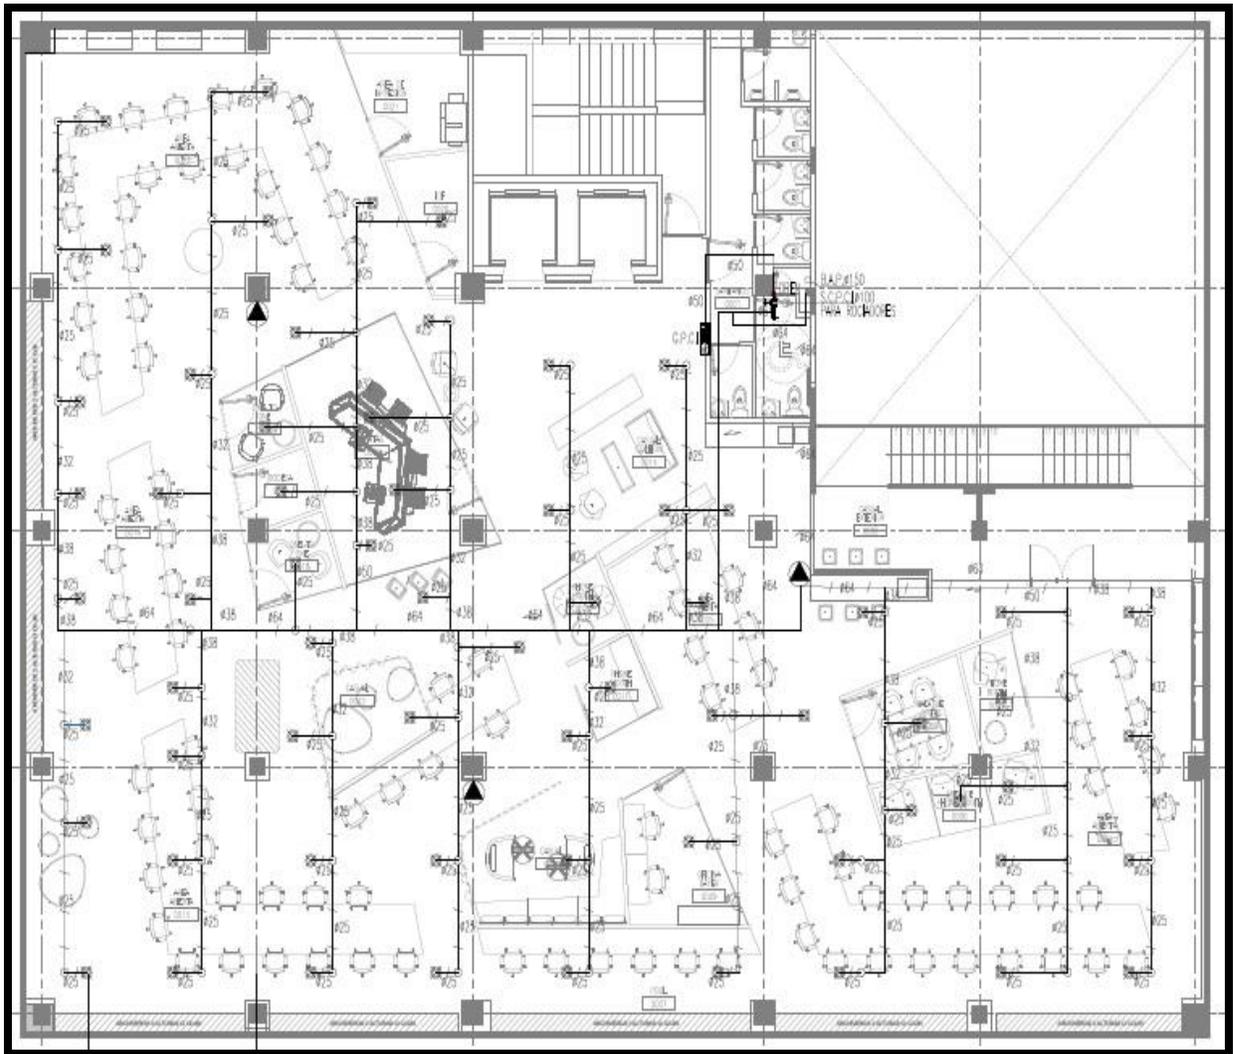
Plano de planta tipo. Boletín PCI-JWT.
